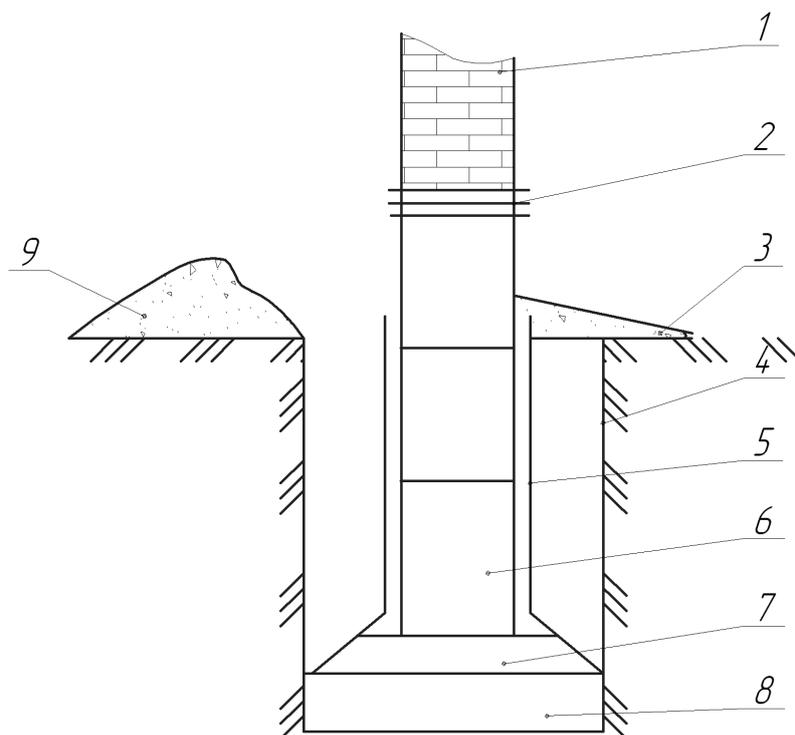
Гидроизоляция фундамента из сборных железобетонных конструкций: 1- кирпичная кладка; 2 - гидроизоляция стены; 3 - отсotka здания; 4 - траншея под фундамент; 5 - гидроизоляция фундамента; 6 - фундаментный блок; 7 - фундаментная подушка; 8 - песчаная подушка; 9 - грунт для засыпки траншеи
